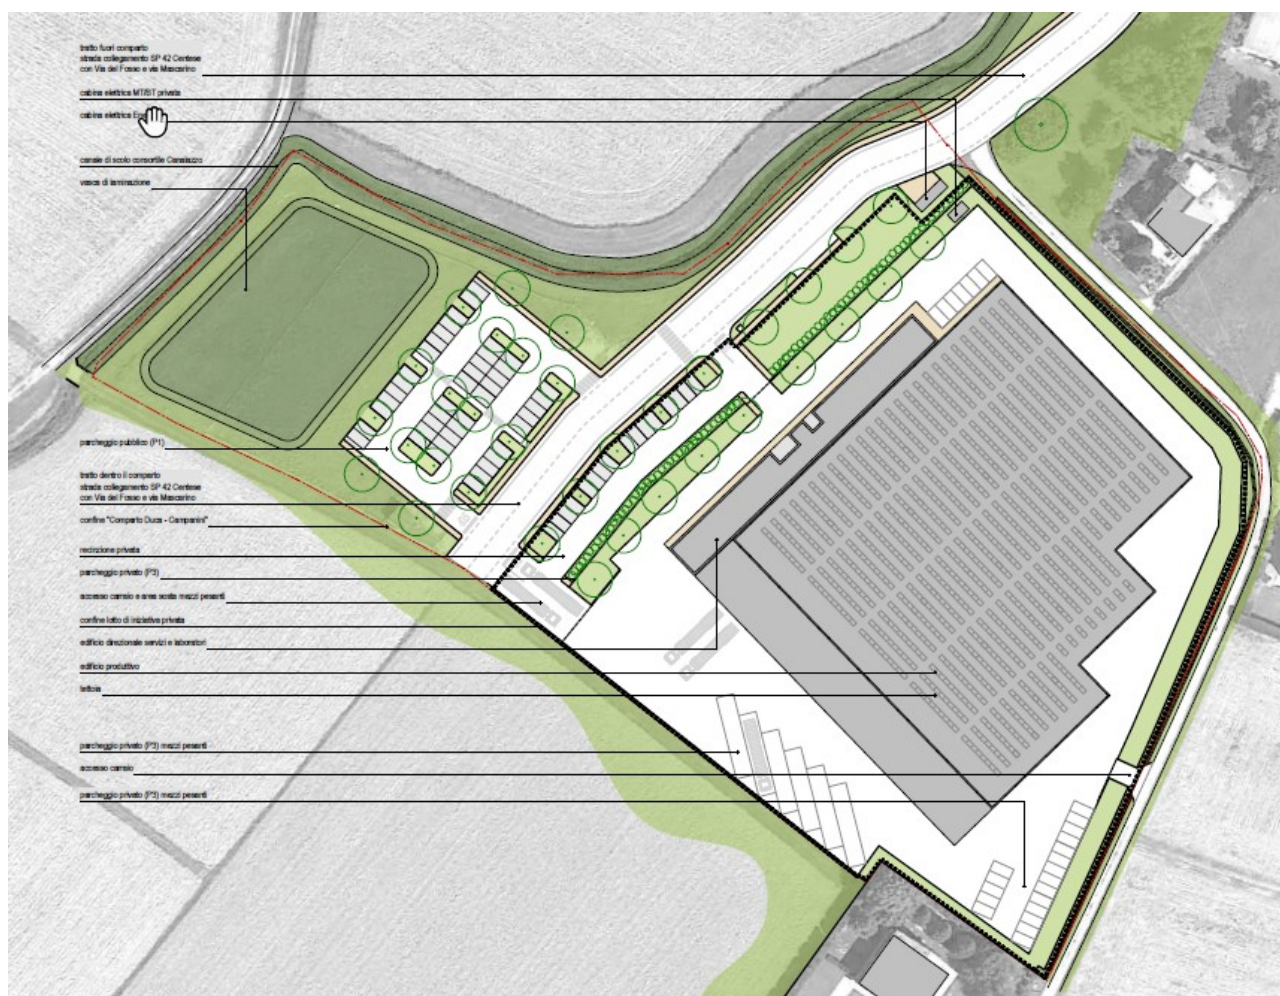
planimetria d'insieme (vedi tavola U004: planimetria generale).
